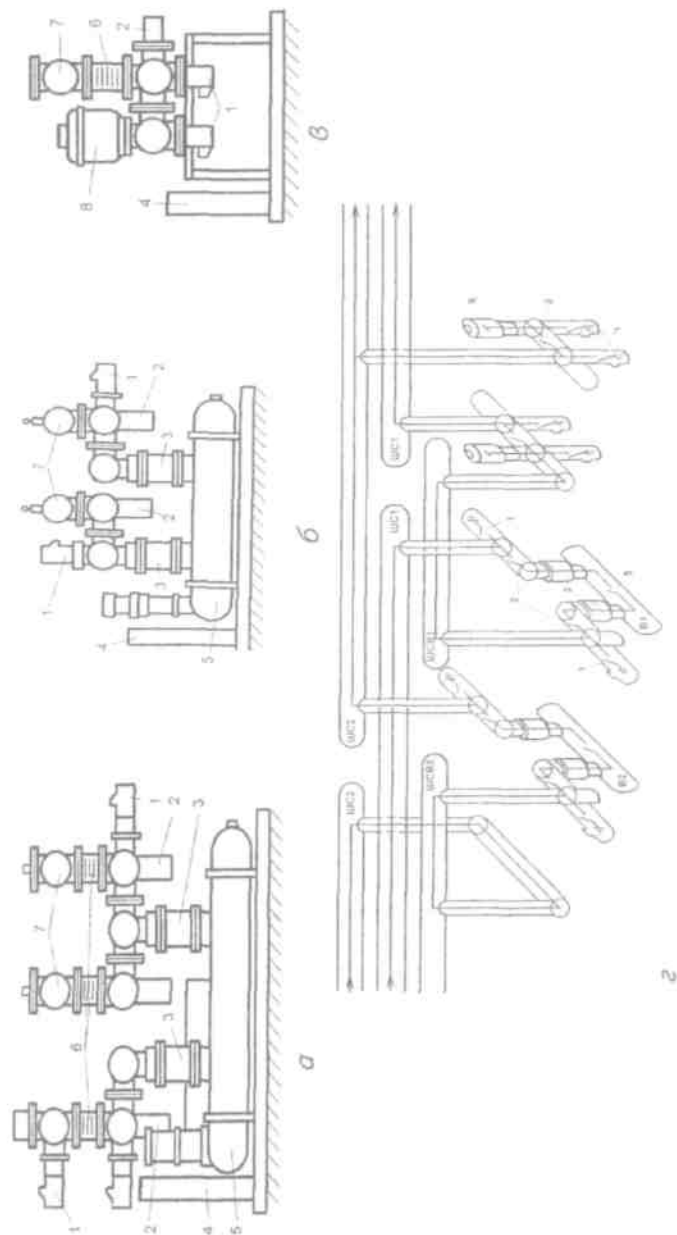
Компонка элегазовых ячеек 110 кВт: а – линейной; б – шиносоединительной; в – трансформаторов напряжения; г – секционной ячейки; 1 – заземлитель; 2 – разъединитель; 3 – трансформатор тока; 4 – шкаф; 5 – выключатель; 6 – сильфон; 7 – шина разъединительная; 8 – трансформатор тока
